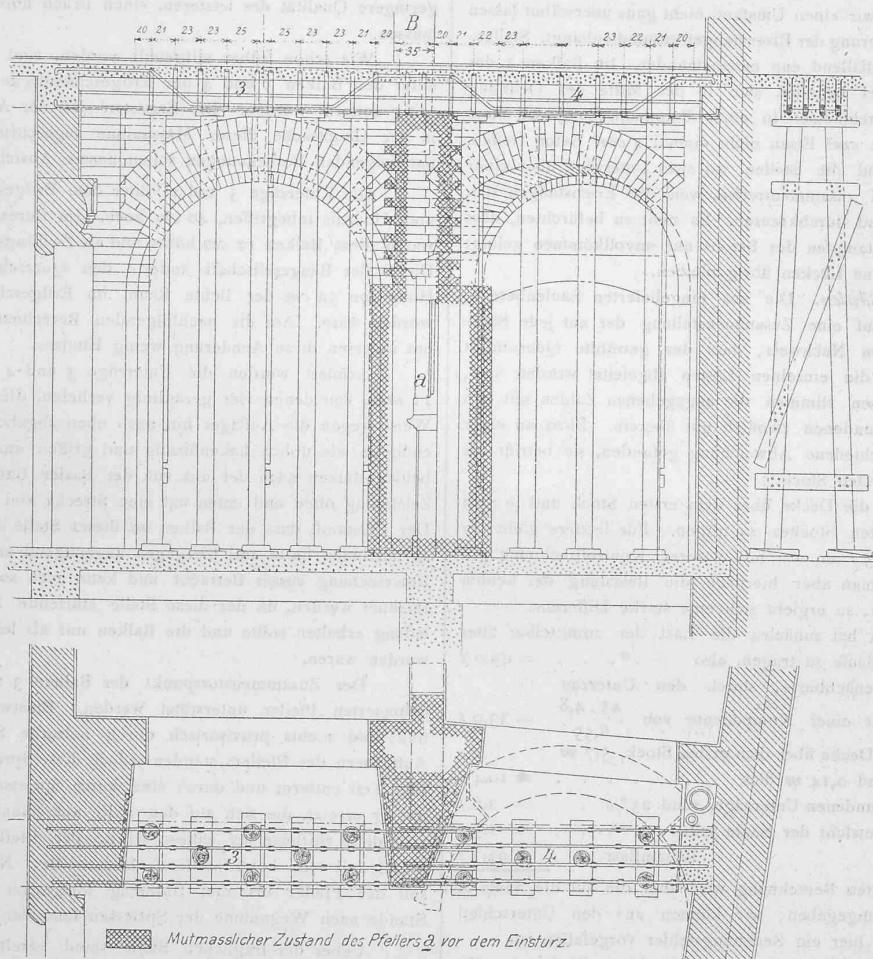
Anordnung von Pfeiler, Unterzug und Bogen in der Vorhalle des Erdgeschosses.
